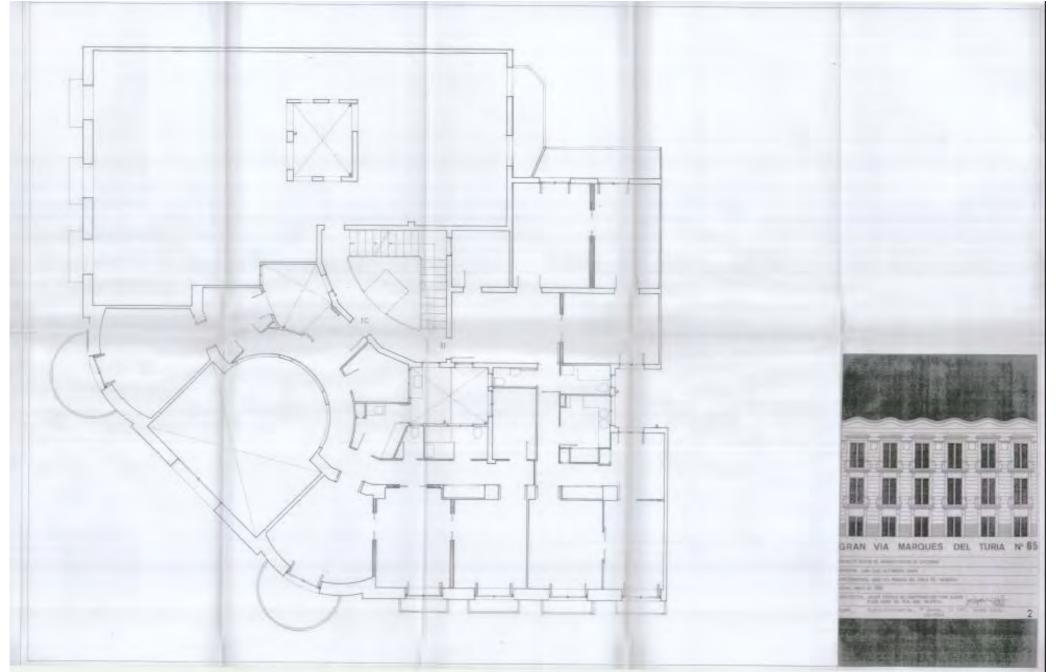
Planta primera estado actual proyecto de rehabilitación 1985
